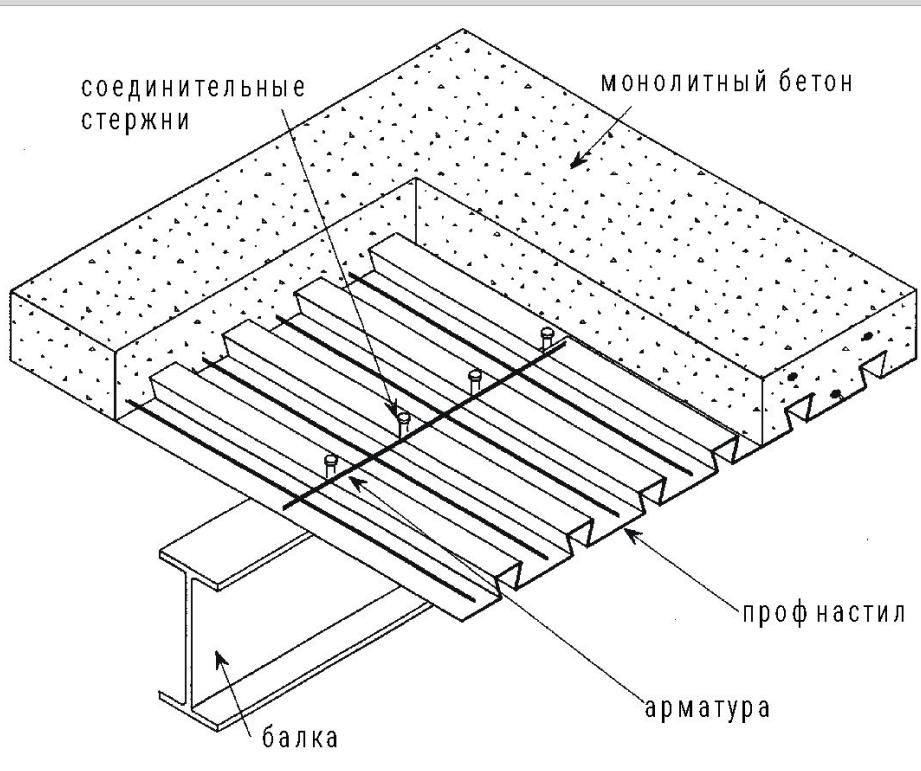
Сталебетонное и сборное плоское перекрытие
